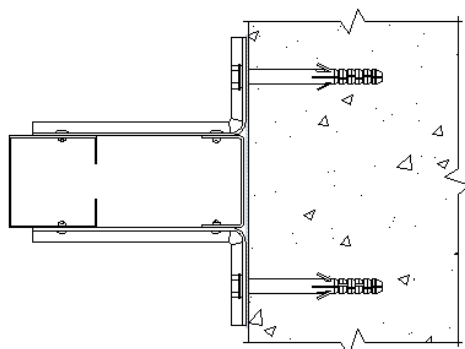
Конструктивная схема для проверки соединений на заклёпках
